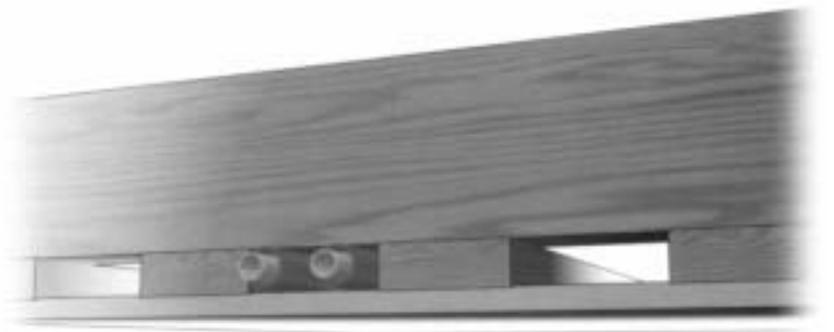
Рекомендуемый вариант укладки труб возле наружной стены (слева)
